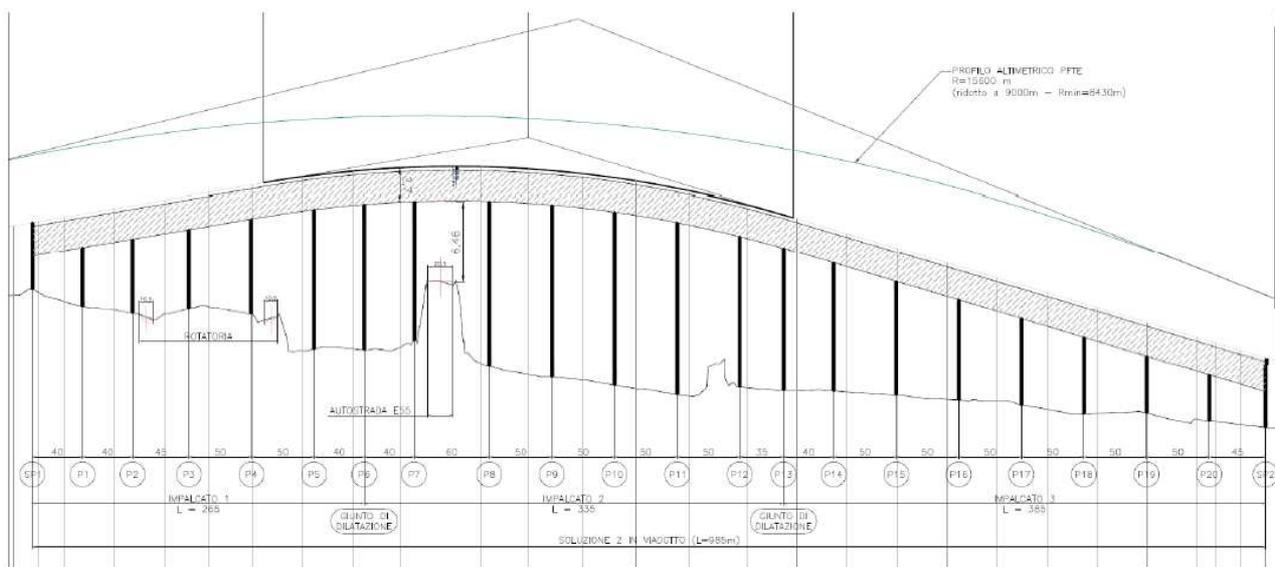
Viadotto A14 – Profilo stradale longitudinale
